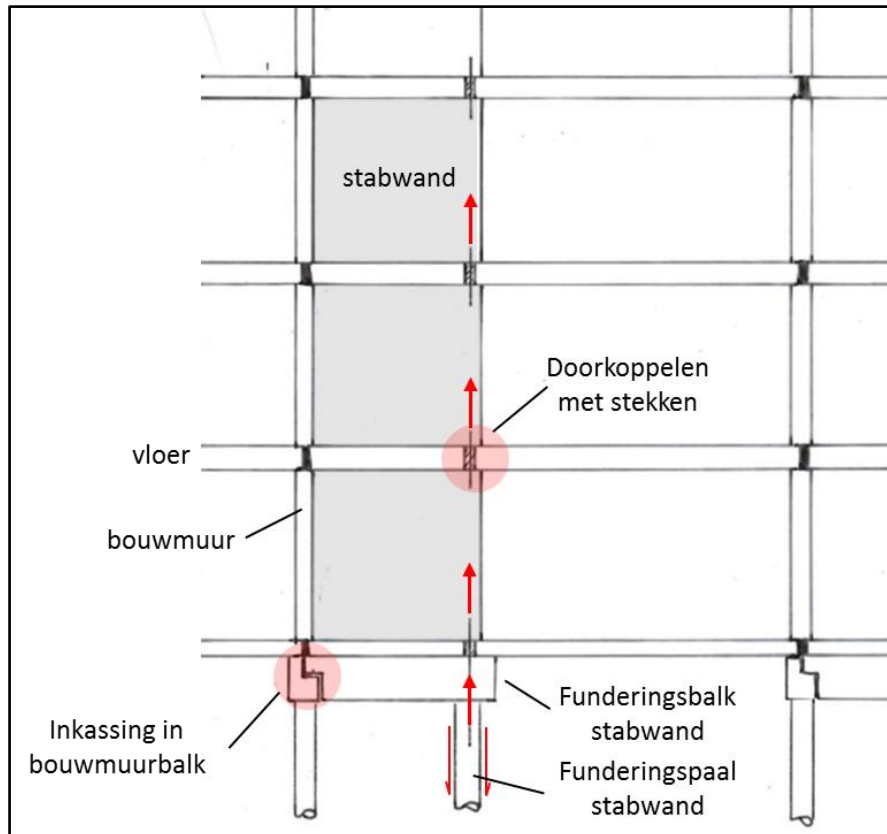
Beukbrede funderingsbalk onder stabwand, doorsnede stabwanden.
